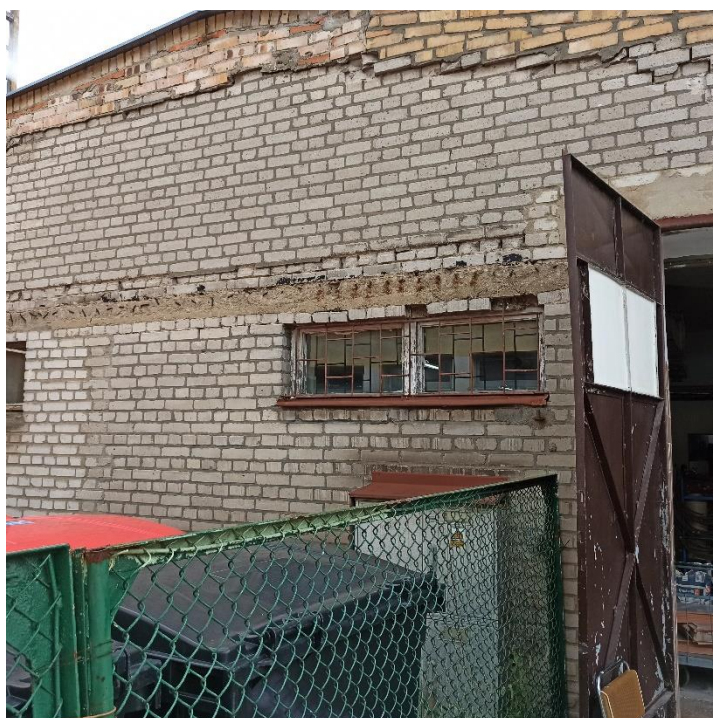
Elewacja północna – brak obróbki parapetów; wypaczone skrzydła, łuszcząca się farba i ubytki kitu w oknach drewnianych; korozja metalowych krat
